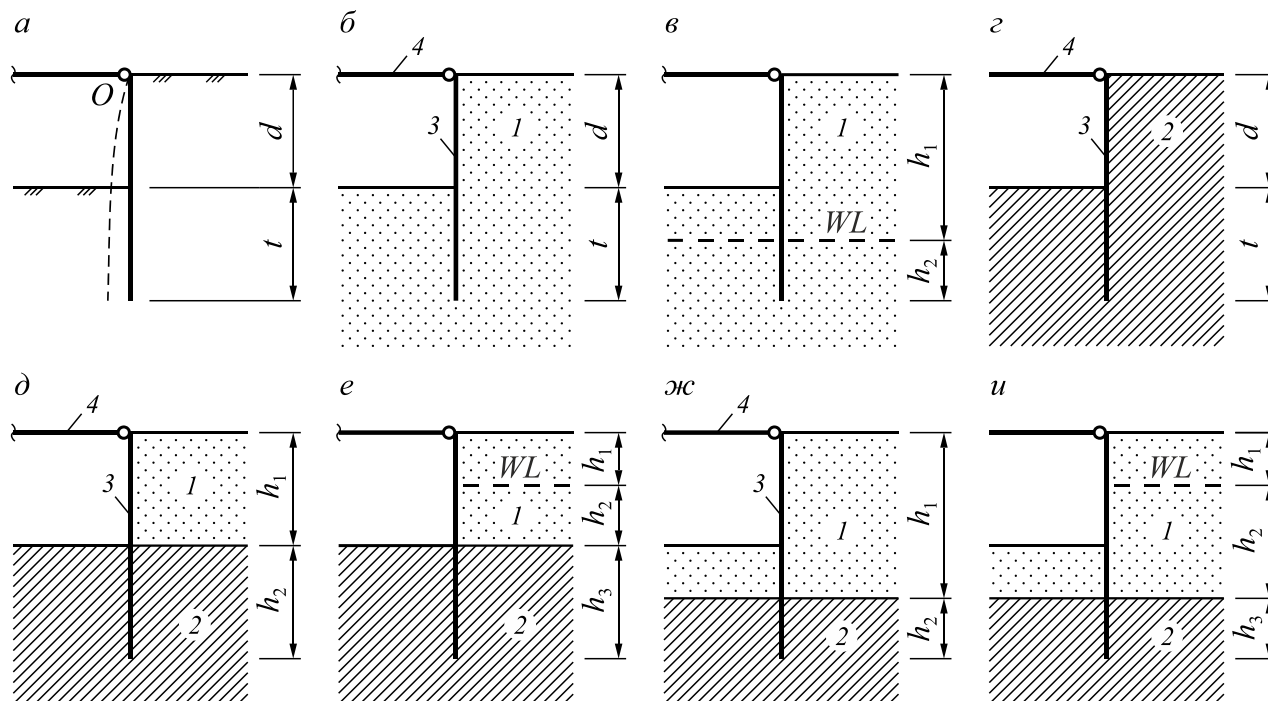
Схема деформирования раскрепленной шпунтовой стенки (а) и варианты грунтовых условий (б – и): 1 – сыпучий грунт ($\gamma_1, \gamma_s, e, \varphi_1$); 2 – водоупорный грунт (γ_2, φ_2, c_2); 3 – шпунт; 4 – распорка
